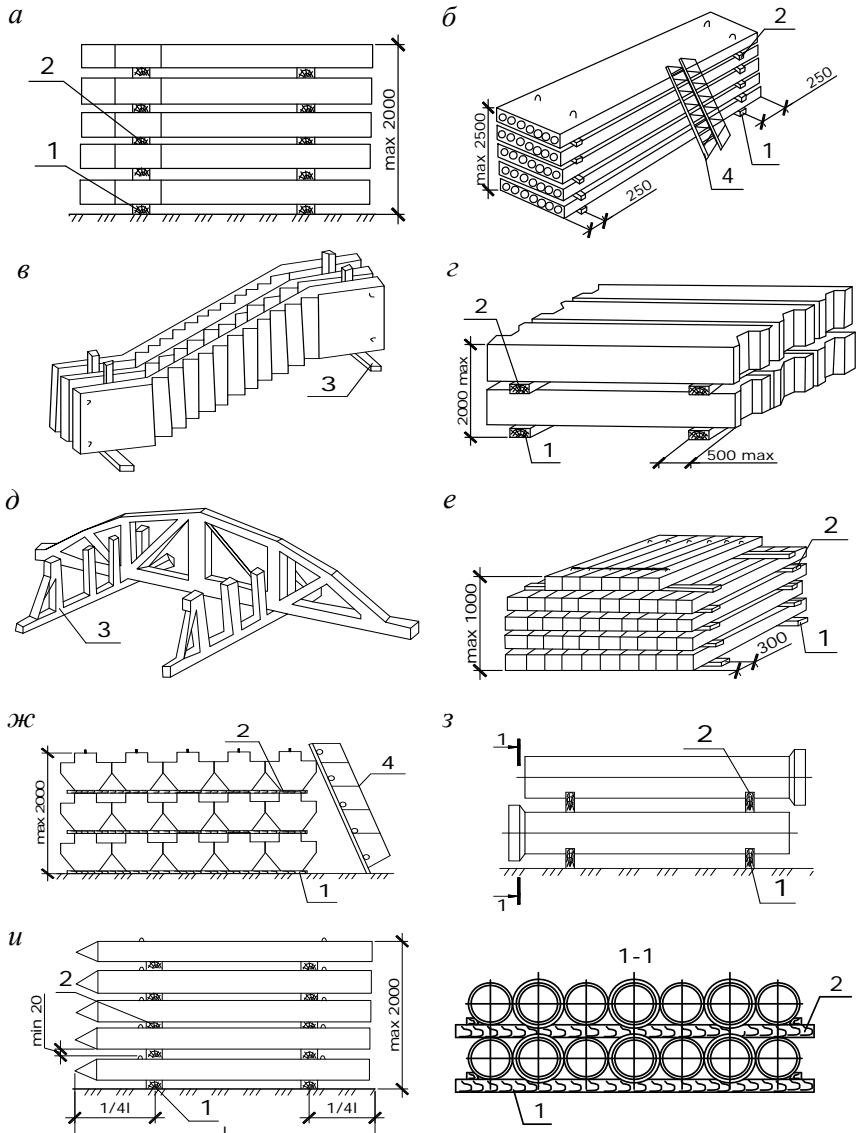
Примеры складирования сборных железобетонных конструкций:
